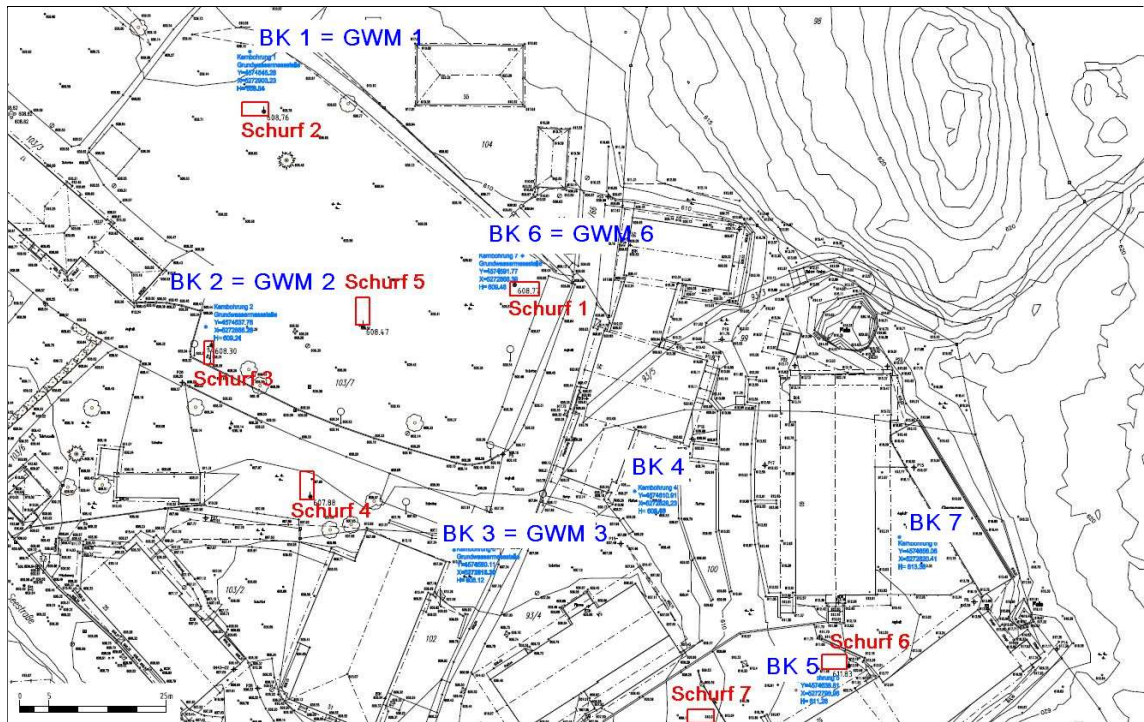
Lageplan Ausschnitt (ohne Maßstab) mit Lage der Schürfe, Kernbohrungen und Grundwassermessstellen für das Projekt Resort Königssee
